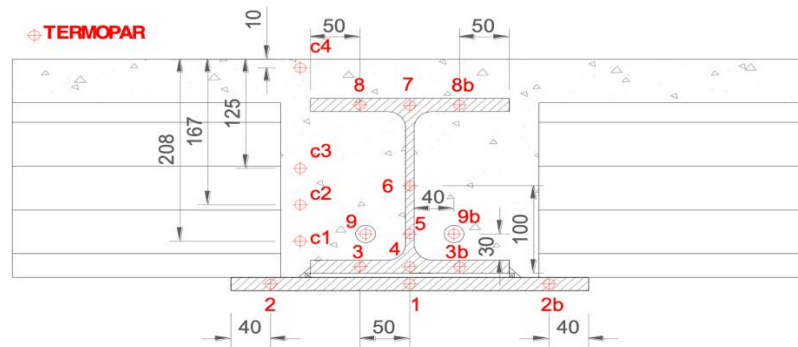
Plano de ubicación de termopares en la sección central. Sección SFB.
